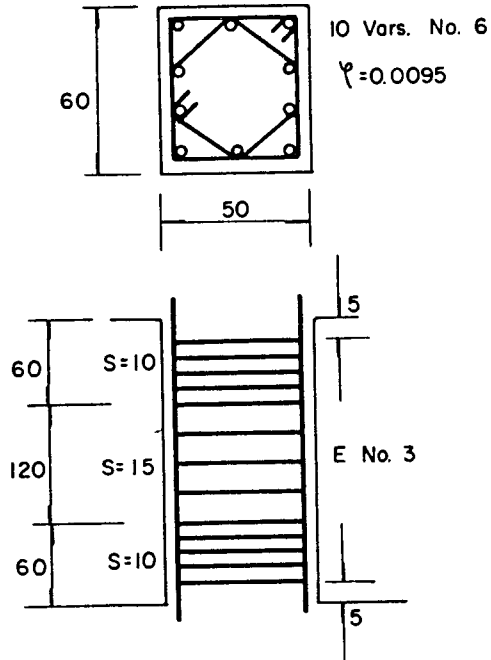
Armado de columnas usando $c=0.6$ y $Q=4$
